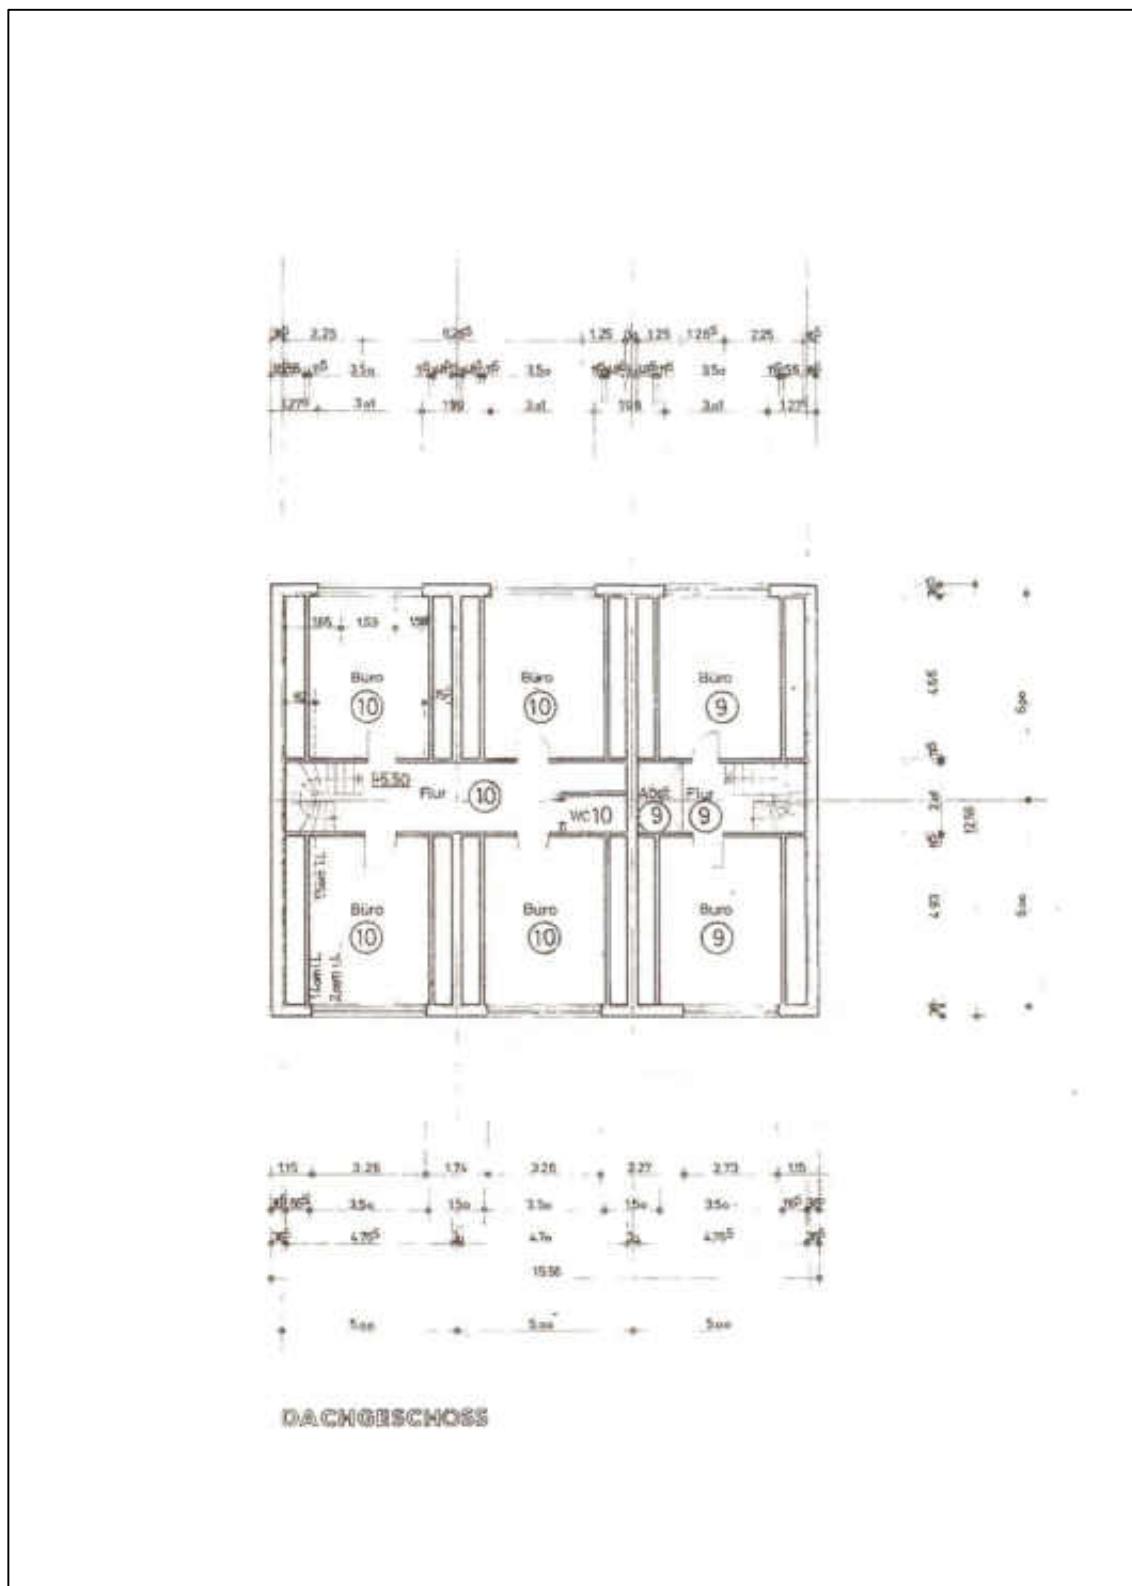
Grundriss vom Dachgeschoß Gebäudetyp C-D
